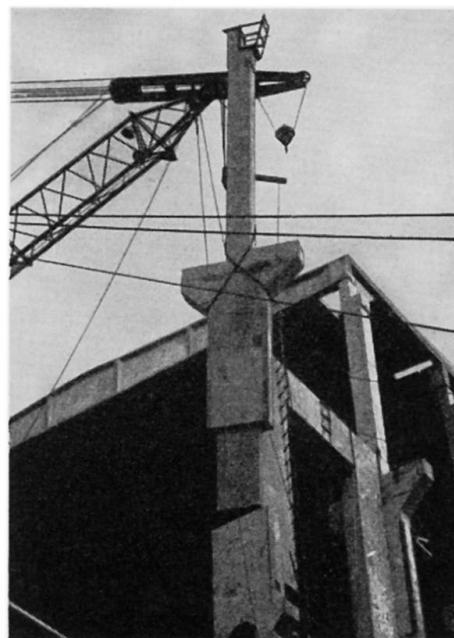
Montage eines Stützenoberbauteiles mit Zapfenstoß.
